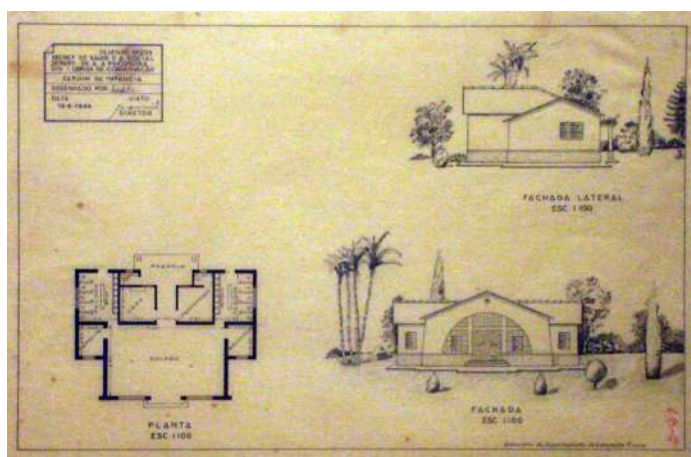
e 173 – Planta e vista do parque infantil (acervo do SIOC e foto do autor – 2007).
